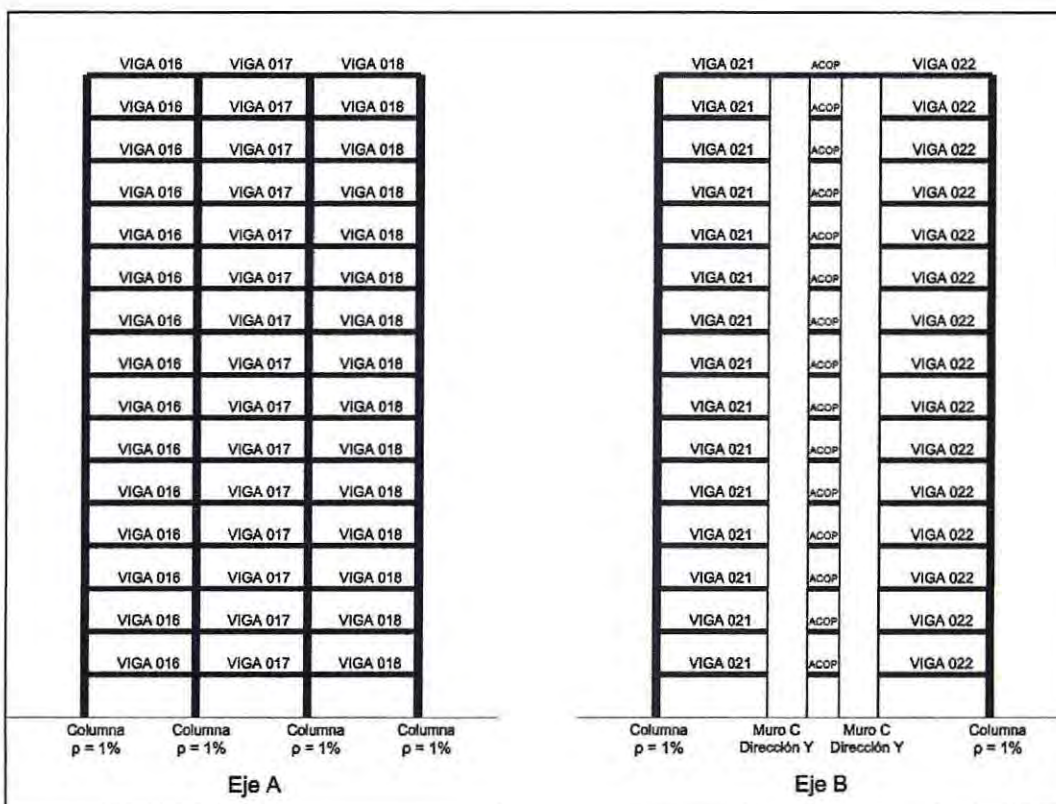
Distribución de vigas en estructura mixta, ejes A y B.
